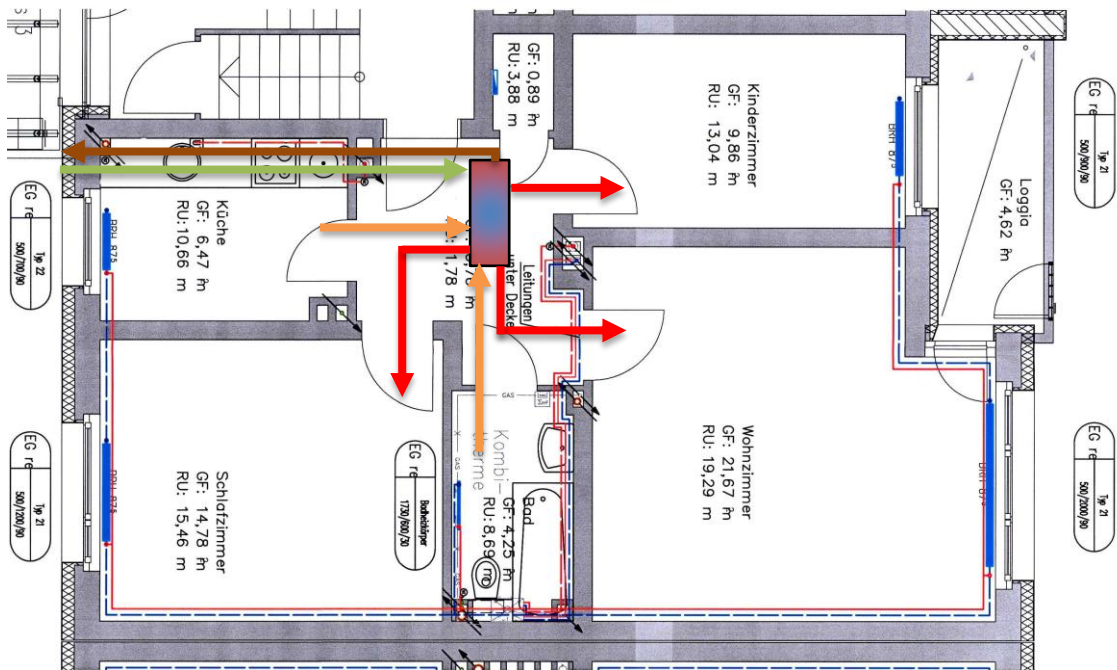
Grundrissausschnitt EG mit fensterlosem Bad eines Mehrfamilienhauses mit Zu-/Abluftsystem, modifizierte Abbildung Firma Grundlach-Wohnungsunternehmen.
